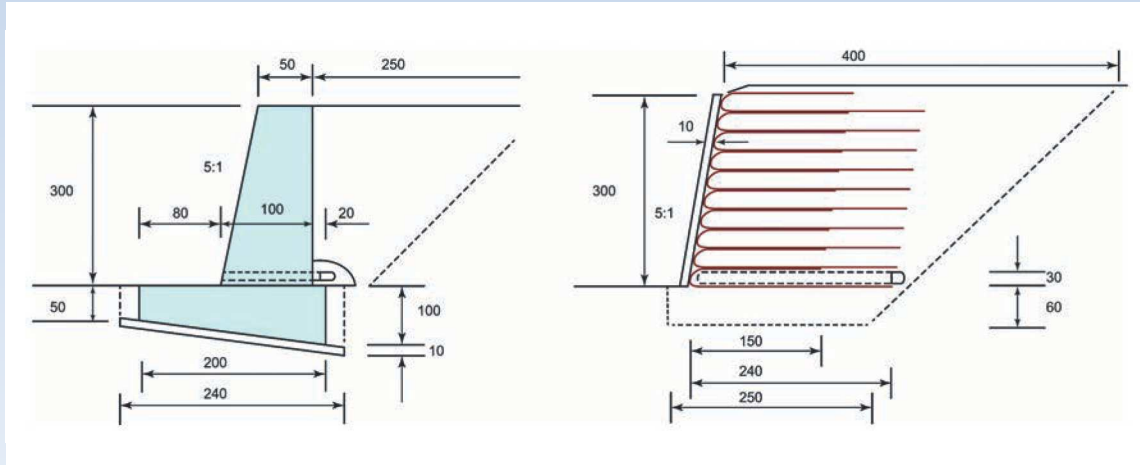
Schematische Darstellung der Stützbauwerke: Betonstützmauer (Fallstudie 4A, links) im Vergleich zur geokunststoffbewehrten Stützkonstruktion (Fallstudie 4B, rechts)
